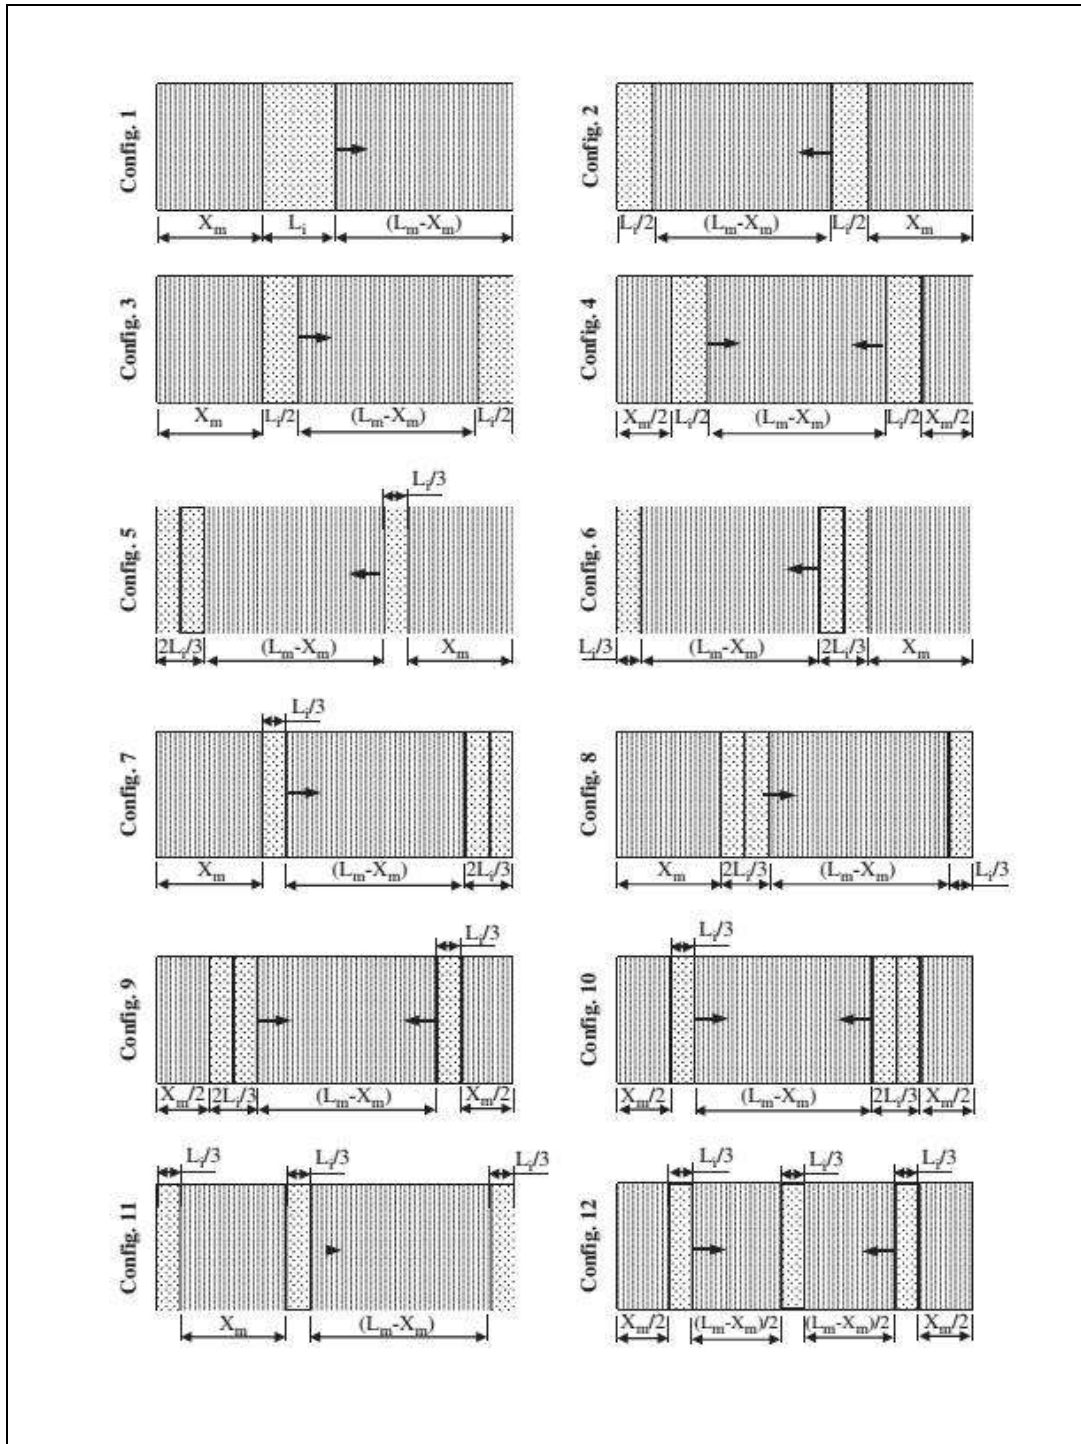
Différentes configurations du mur multicouche étudiées par M Ozel et K Pihili d'un mur en briques ou blocs de béton avec laine de verre ou liège comme isolant [31]
